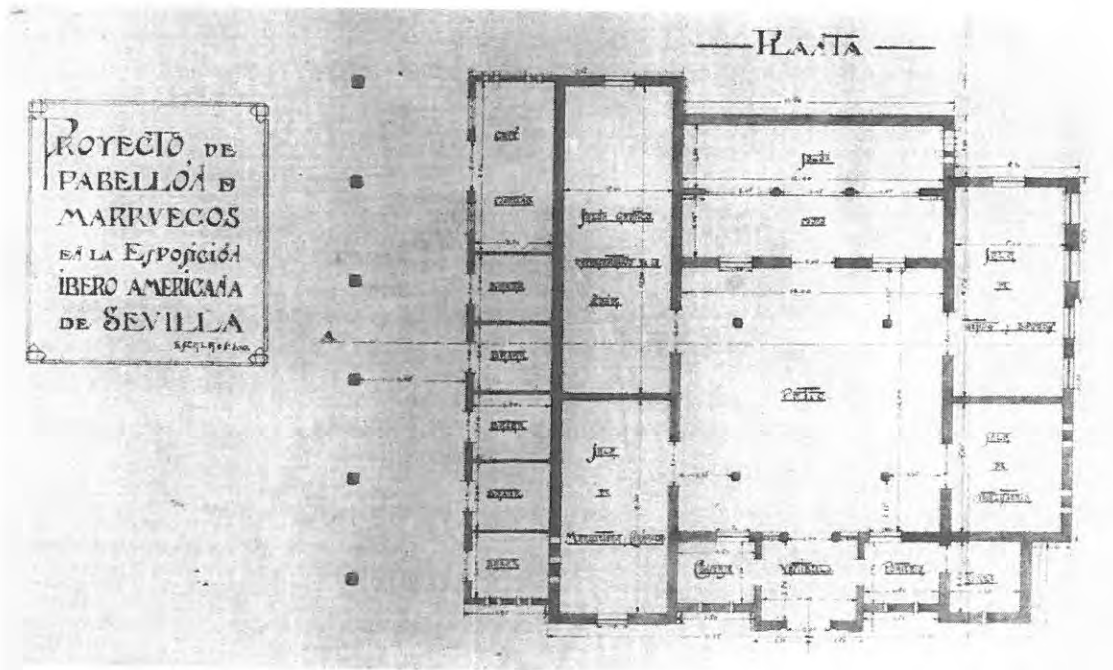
Primer proyecto del Pabellón oficial. Planta.
